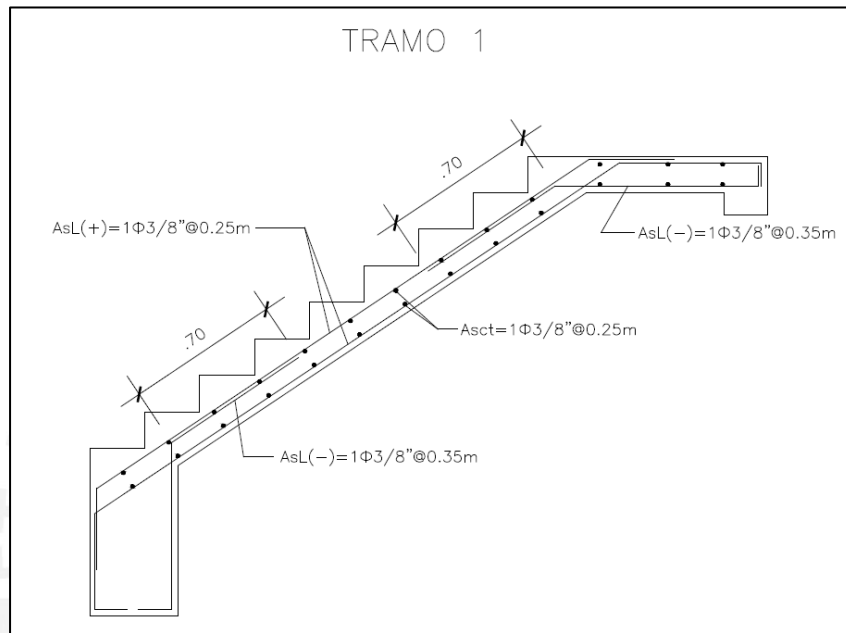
Detalle de acero del Tramo 1 de escalera.
